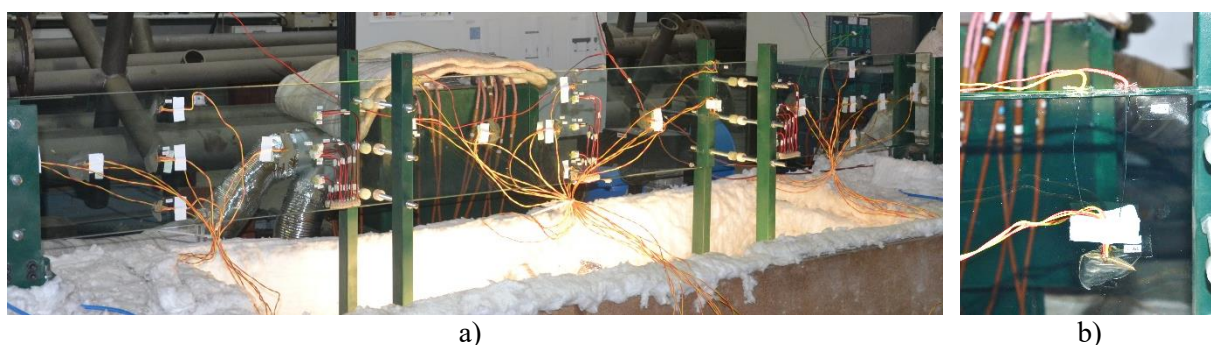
Viga devidamente instrumentada: a) visão global; b) pormenor dos termopares no SG
